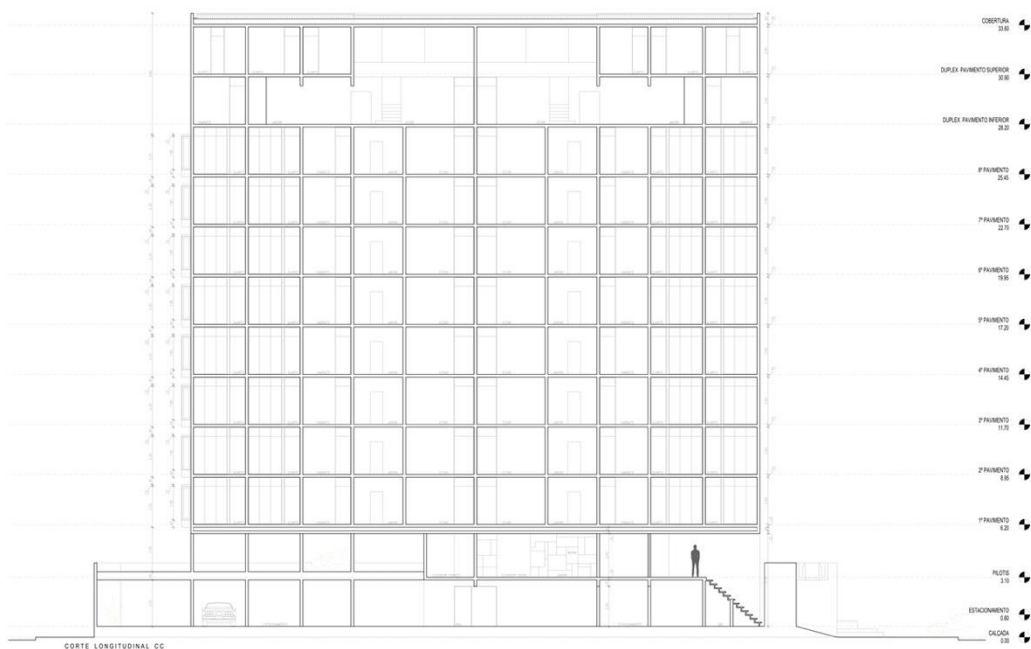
Corte Longitudinal CC do Edifício Vila Mariana, 1976, do arquiteto Tinoco.
